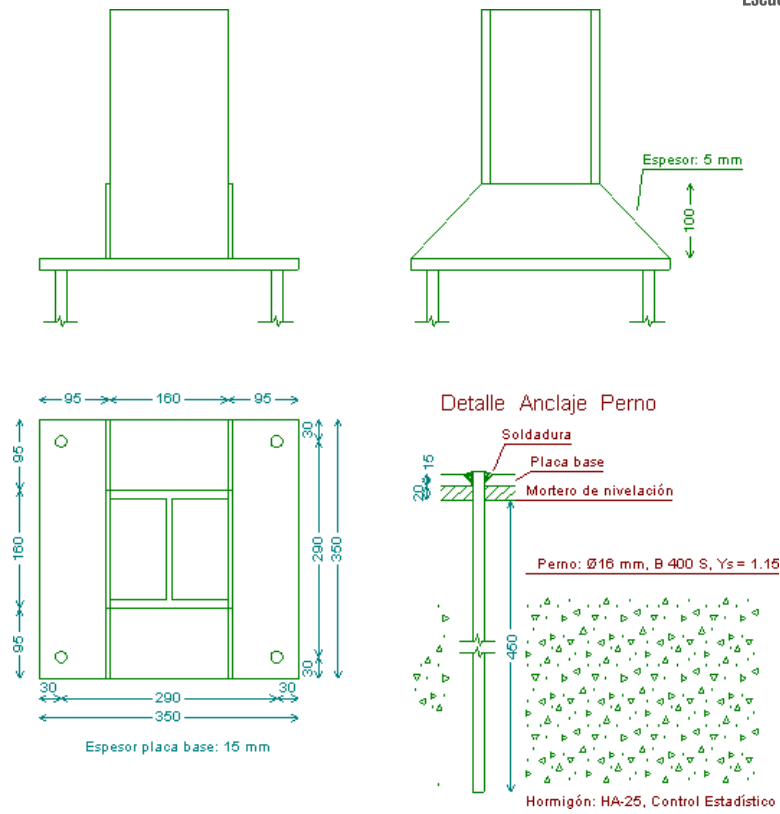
Geometría de la placa de anclaje de los pilares de la ENTREPLANTA.
